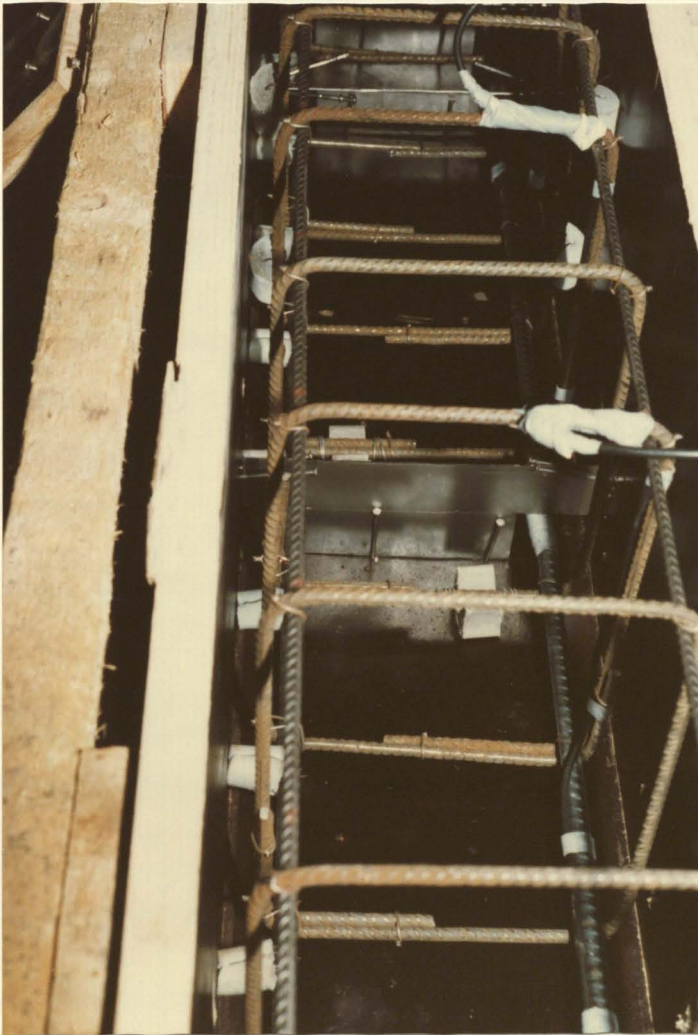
Schalungskörper mit Bewehrung vor der Betonage
